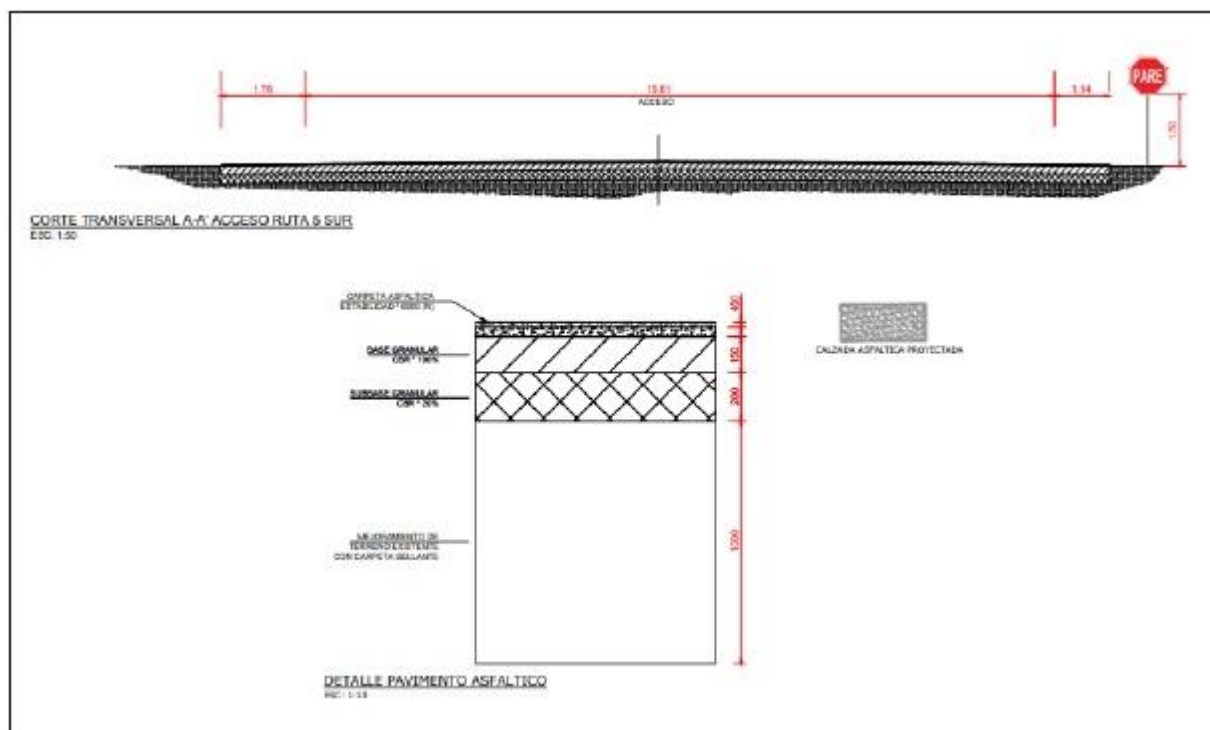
Corte transversal A-A (Figura 29) Acceso Ruta 5.
